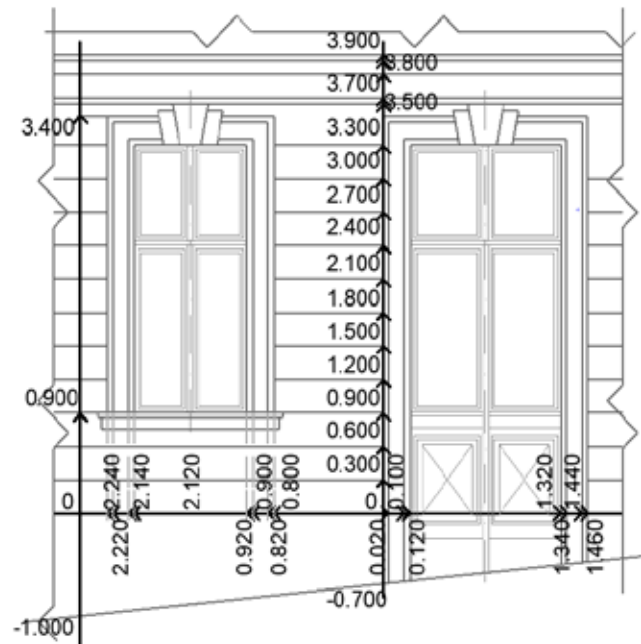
Приклад виконання обмірів – фрагмент фасаду з входом у житловий будинок
